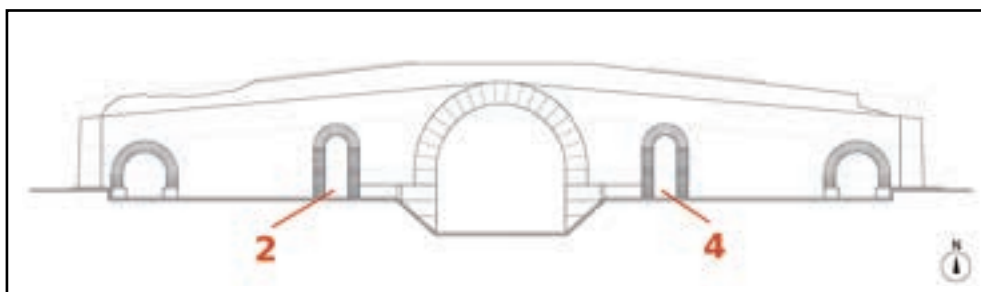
Alzado sur. Puente del Salero (Vicente Sanjuán. Ayuntamiento de Villena)
